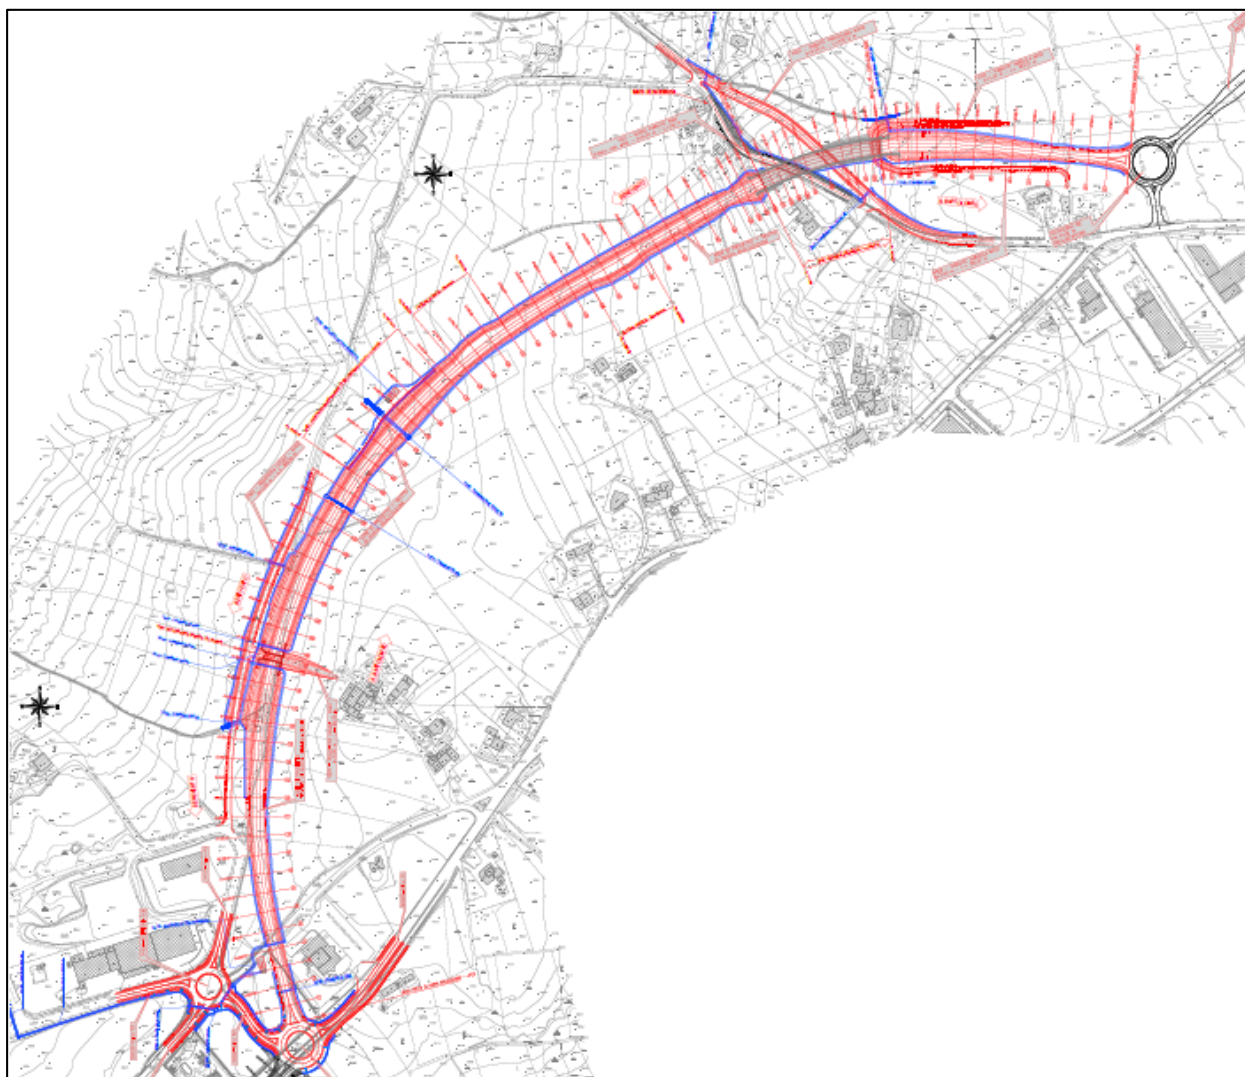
Planimetria di progetto tratto di nuova realizzazione
